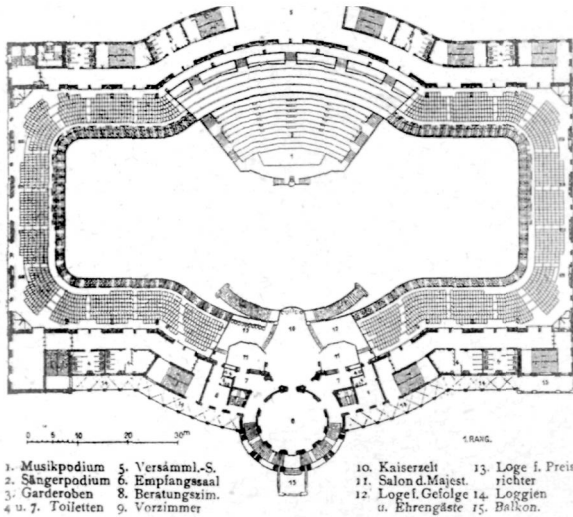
Festhalle zu Frankfurt a. M. Grundriß
